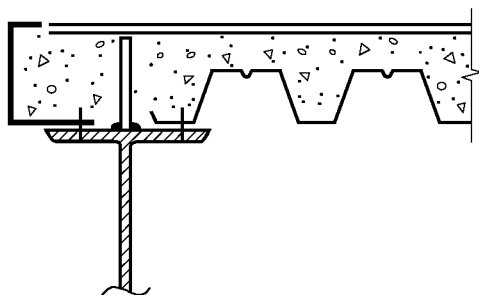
Монолитные плиты перекрытий с опалубкой из стального оцинкованного настила
